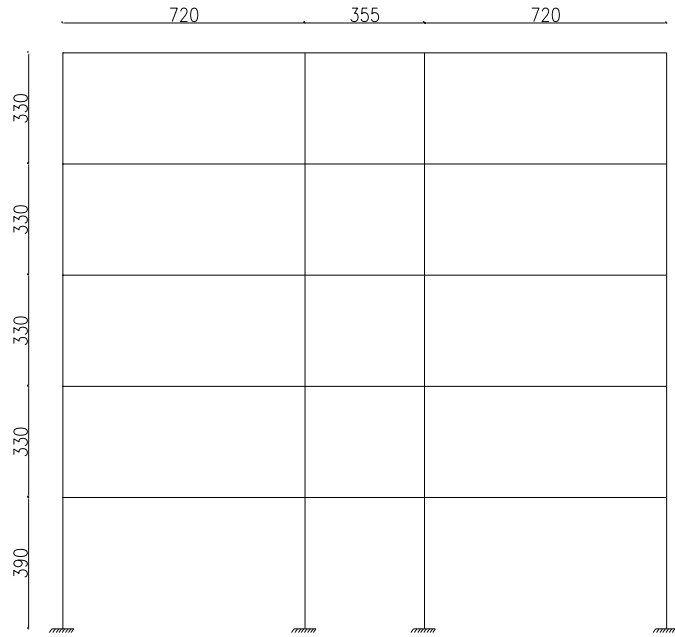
Yapının Mevcut Taşıyıcı Sistem Planı
